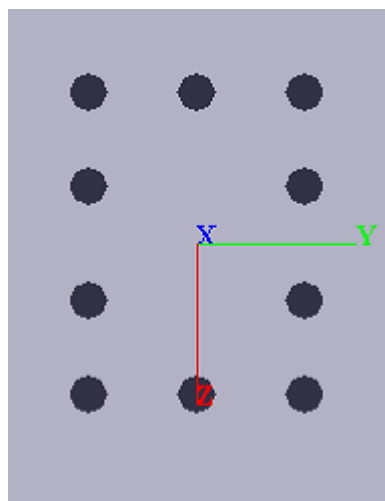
Vista planimetrica del modello GROUPv2016.
